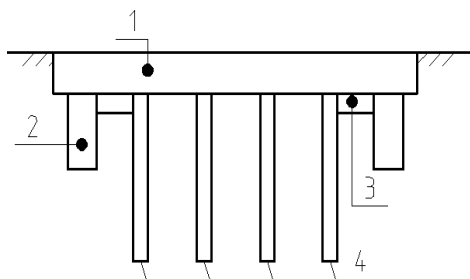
Конструктивная схема плитно – ребристого свайного фундамента:
